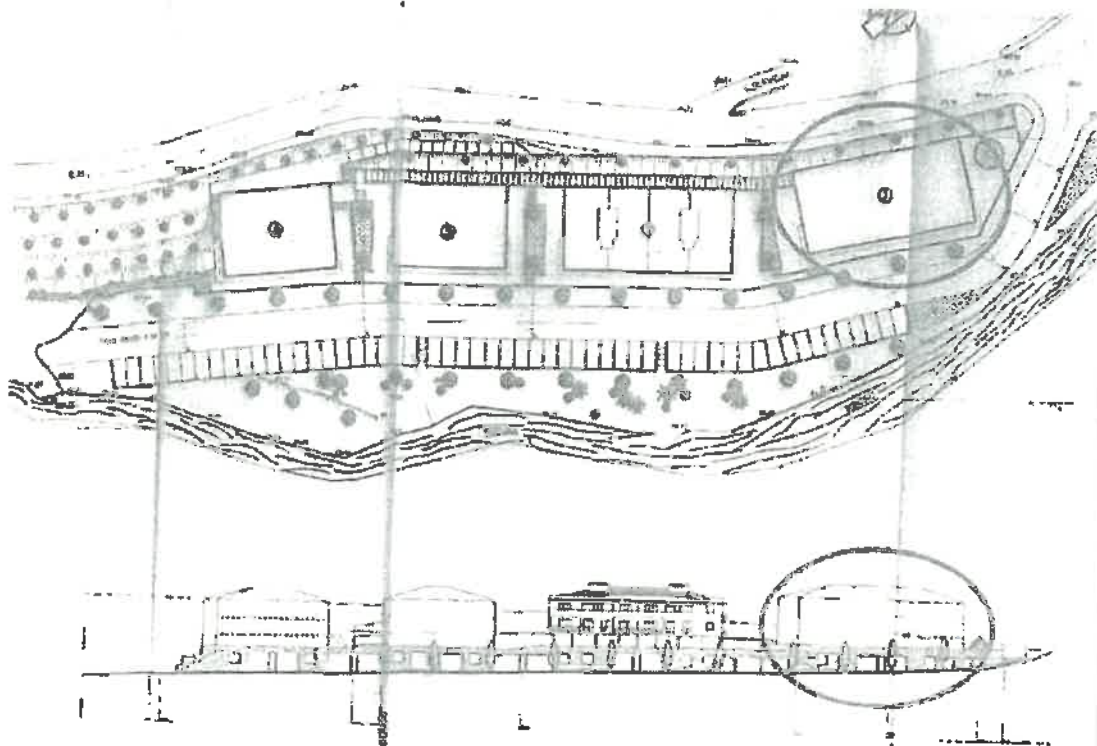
Extrato da planta do pretenso loteamento, com lote 1 assinalado
